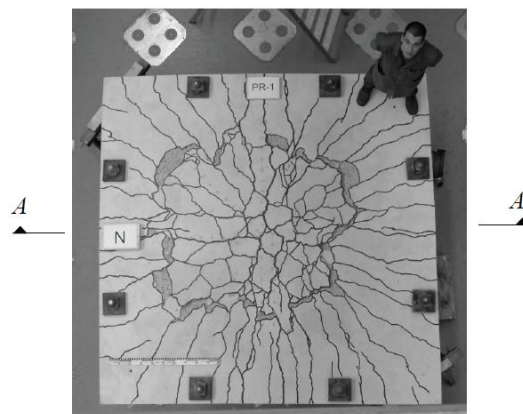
Vista de topo do cone de punçoamento da laje do ensaio PR1 [2]
